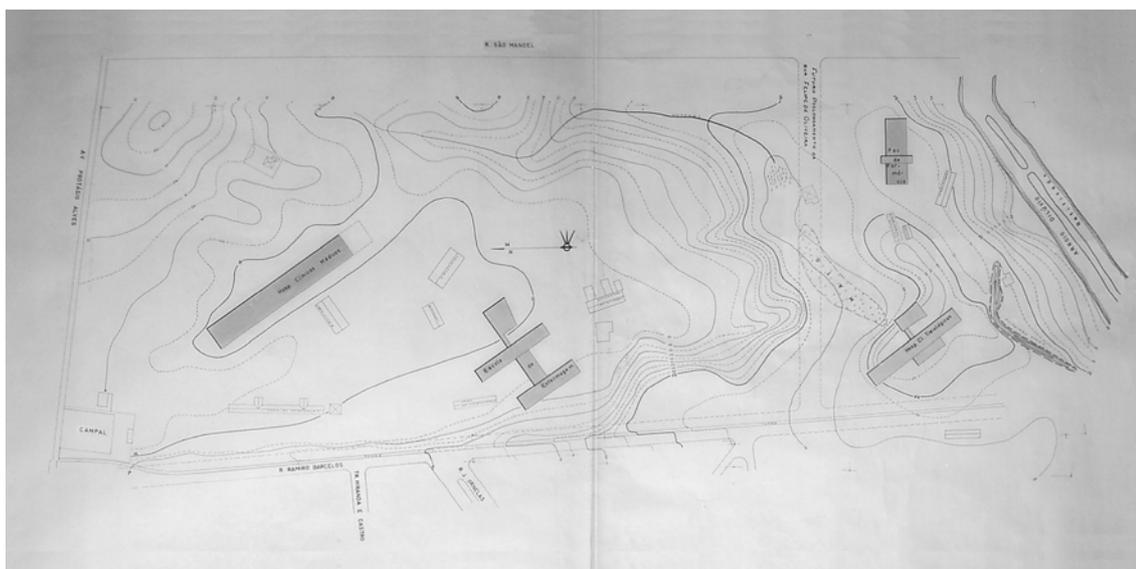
planta do terreno do Centro Médico – 1955 (Arquivo da Sub-Prefeitura do *Campus* Saúde)
